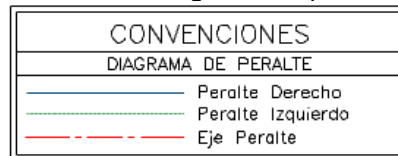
Bloque de convenciones en perfil, plantilla planta perfil
